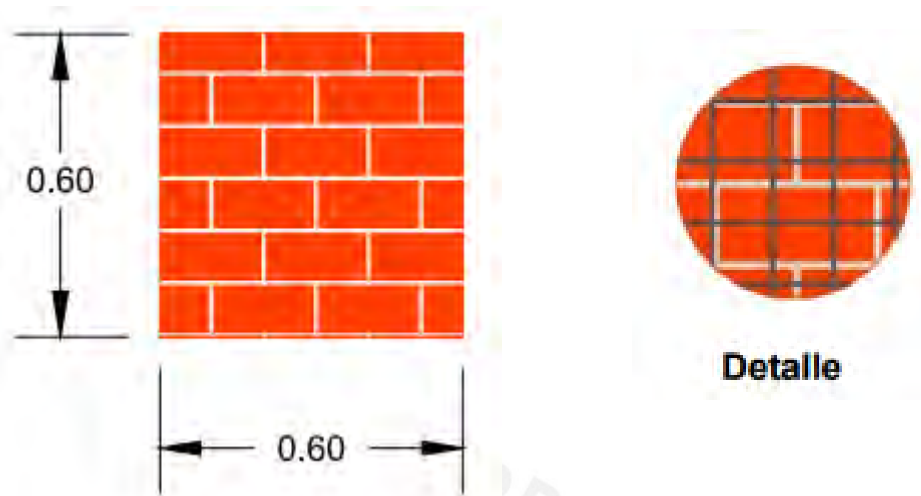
Murete reforzado con malla electrosoldada (Tipo M3)
